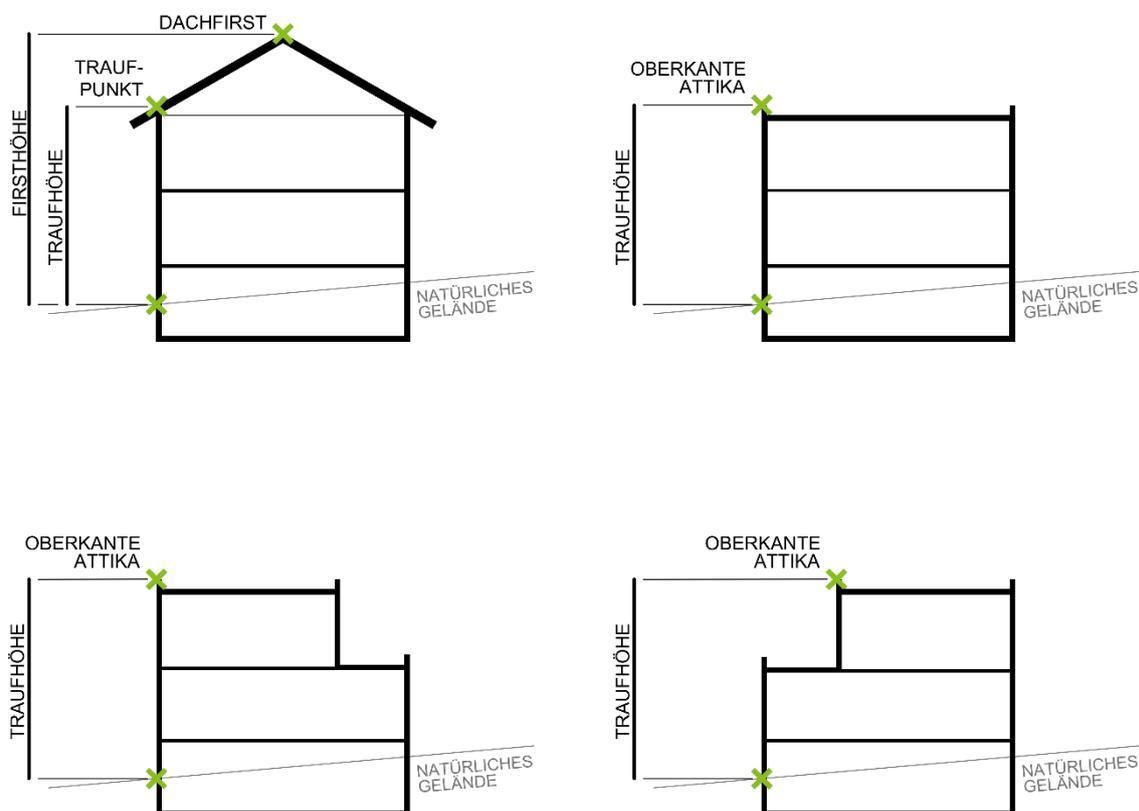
Systemskizze Bezugspunkte bei gegeneinander laufenden Dachflächen und Flachdächern, ohne Maßstab (Darstellung BSMF mbH)
